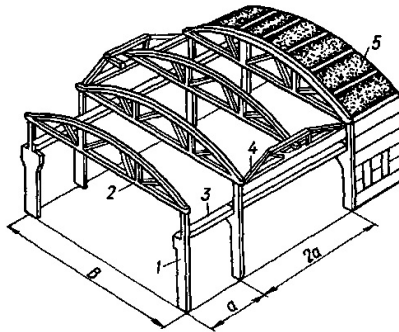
Каркас одноповерхової будівлі (залізобетонний):
